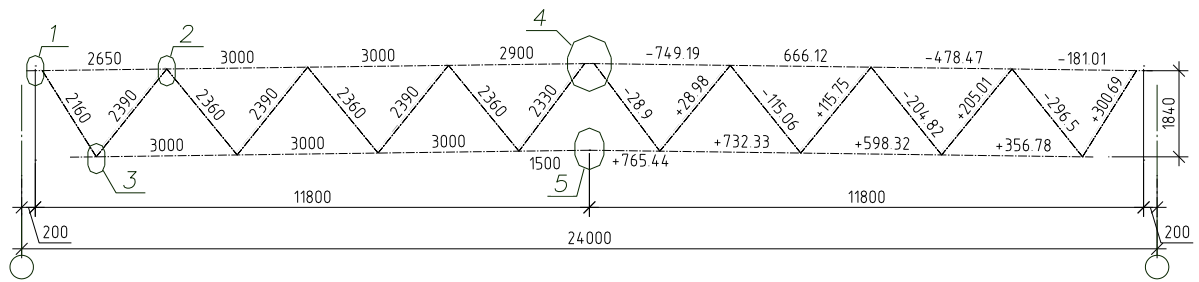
Схема расположения узлов к расчету и конструированию узлов фермы
